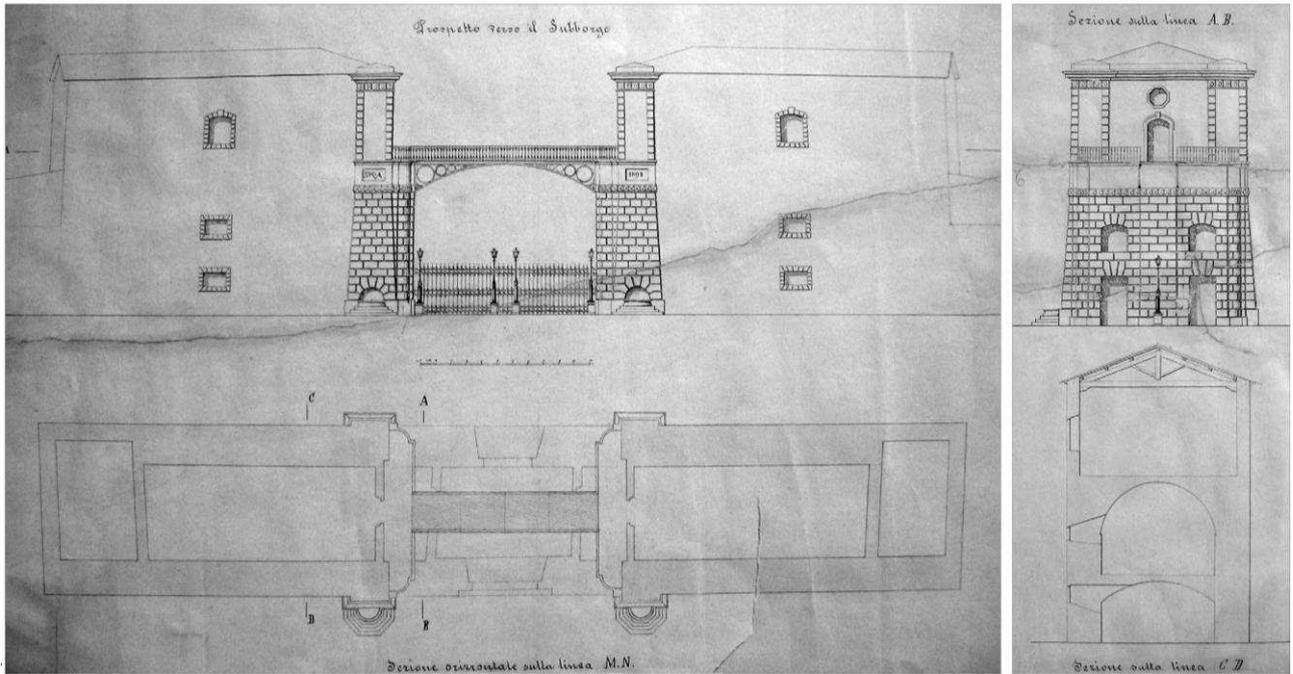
Secondo progetto definitivo: abbattimento, a tutta altezza, della parte centrale e collegamento tra le due parti tramite ballatoio in ferro, 1893 (Archivio di Stato di Arezzo, *Piante sciolte del Comune di Arezzo*, 3 (Progetto di sistemazione della Porta S. Spirito nella città di Arezzo, progetto II^o)).
